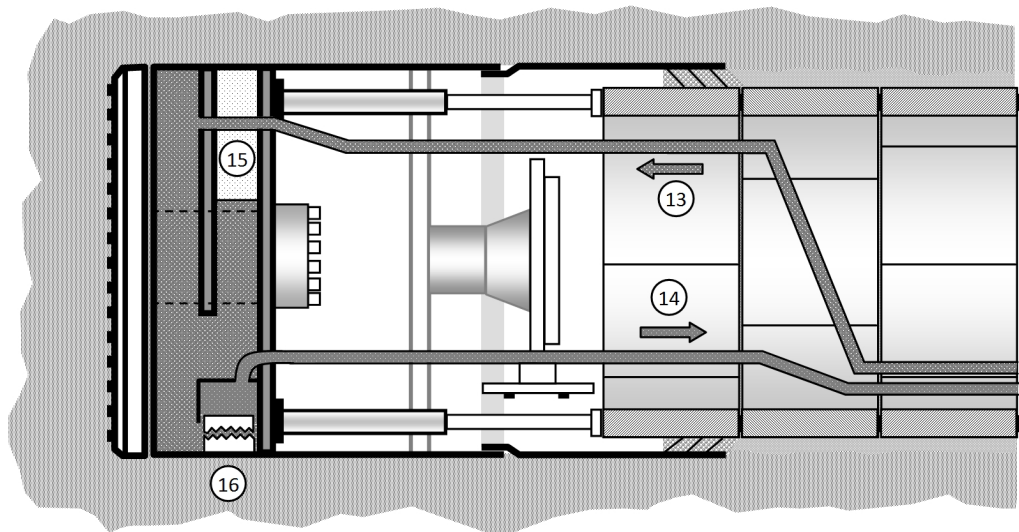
Coupe schématique d'un tunnelier à pression de boue.
